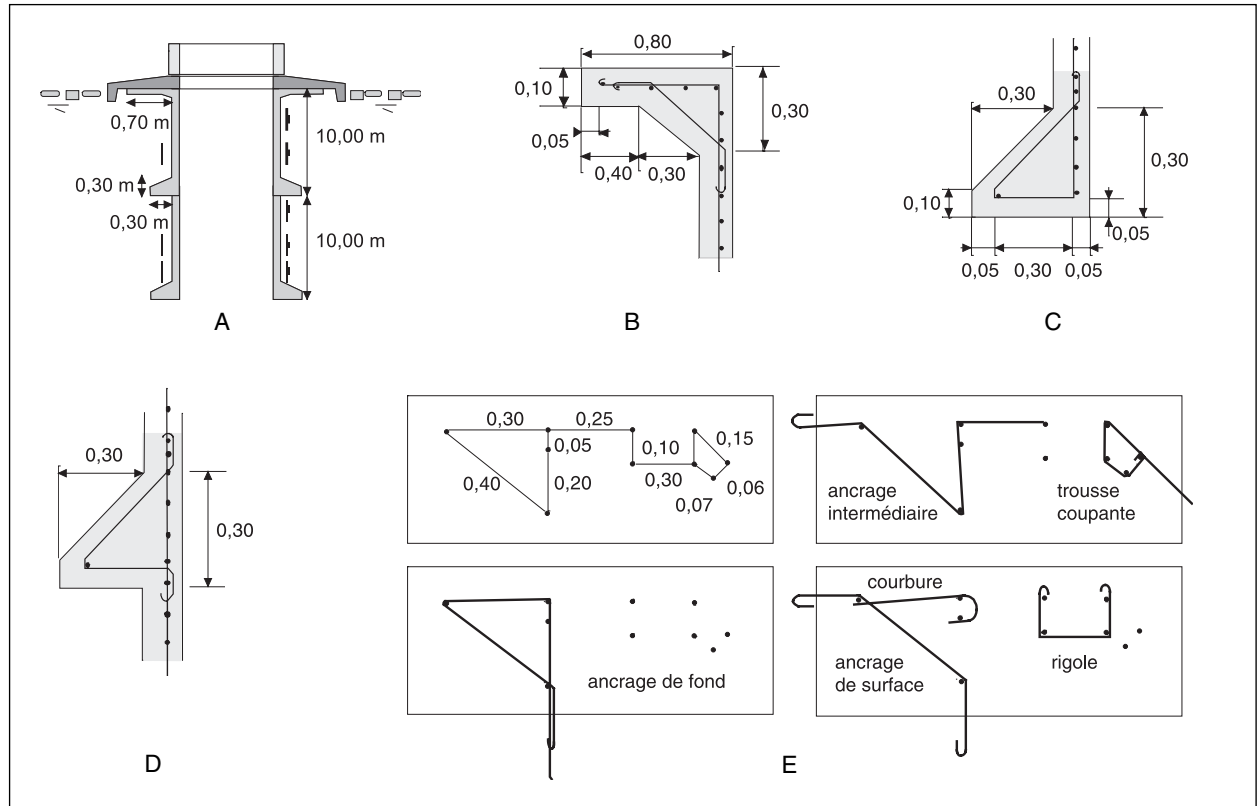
Plan de ferrailage des ancrages du cuvelage.
